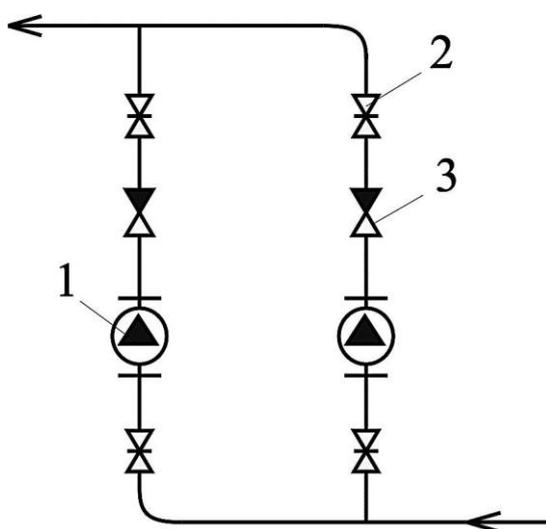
Схемы присоединения труб к бесфундаментным циркуляционным насосам:
